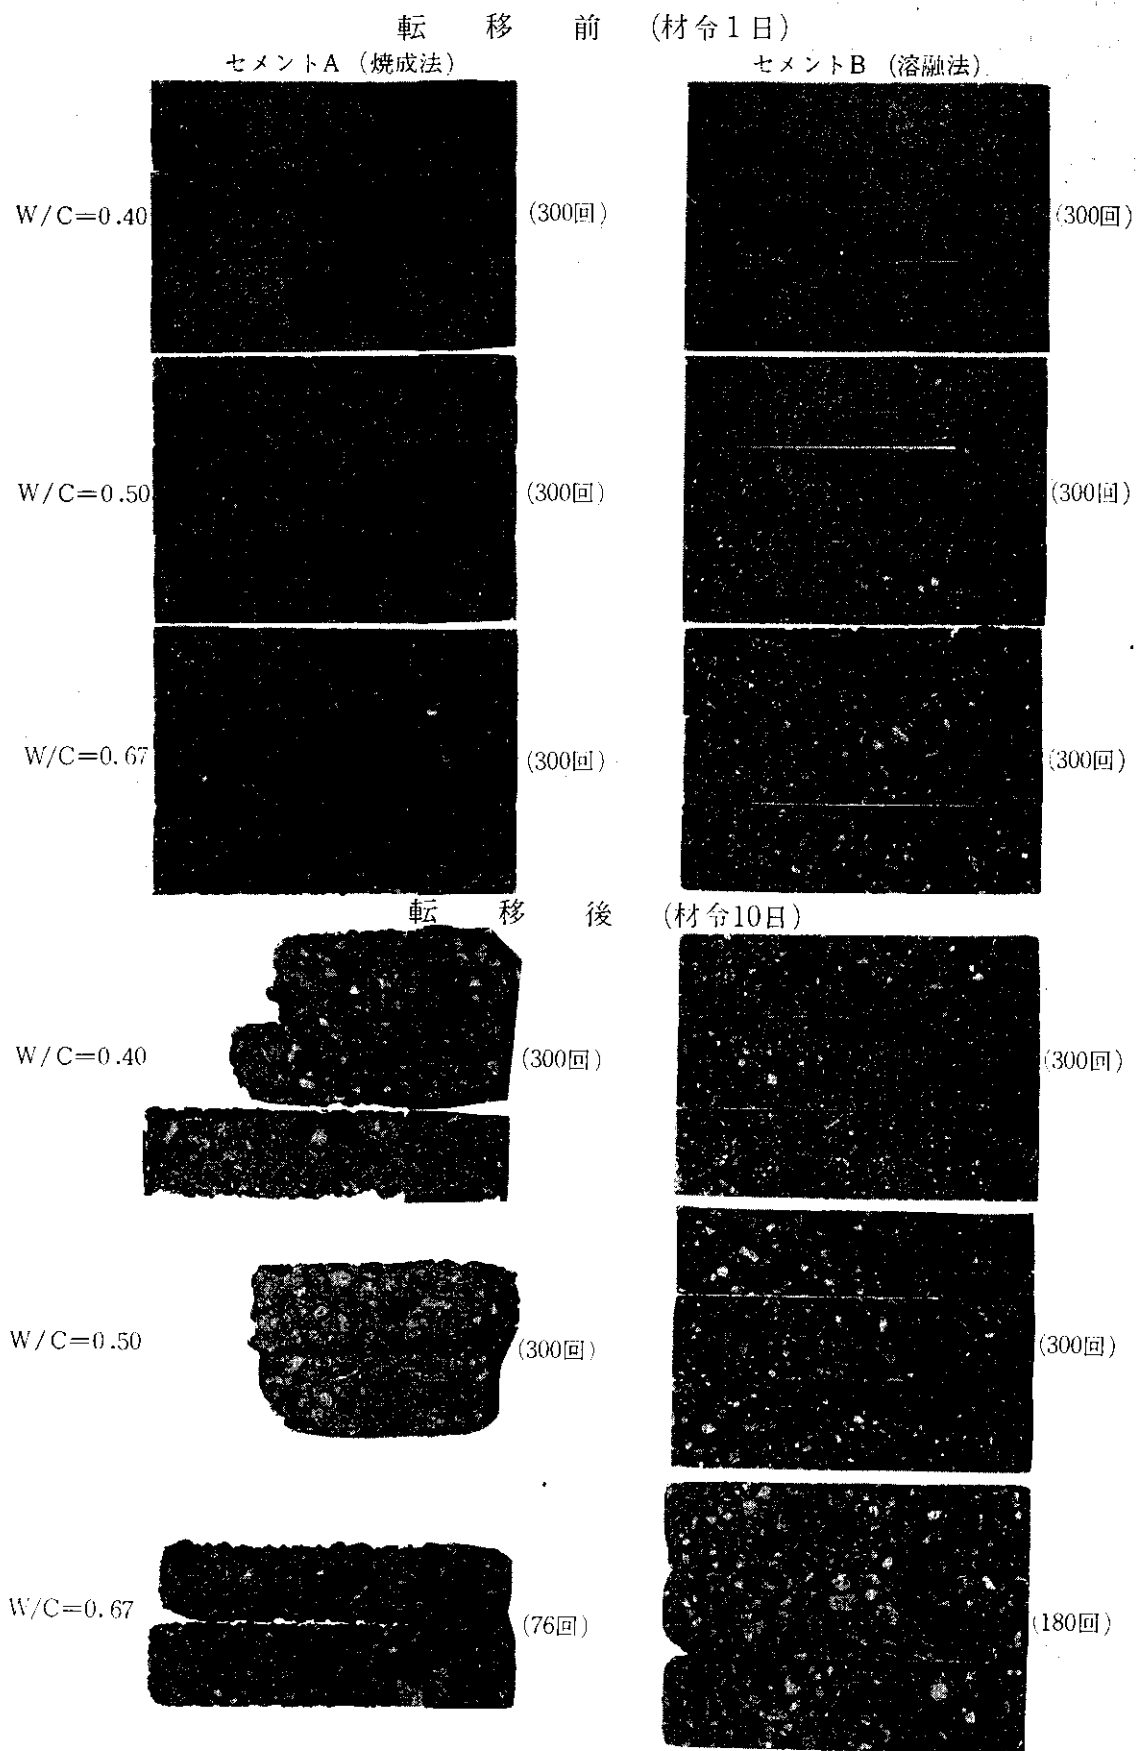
供試体製作時上面の外観変化状況 (AE コンクリート)
